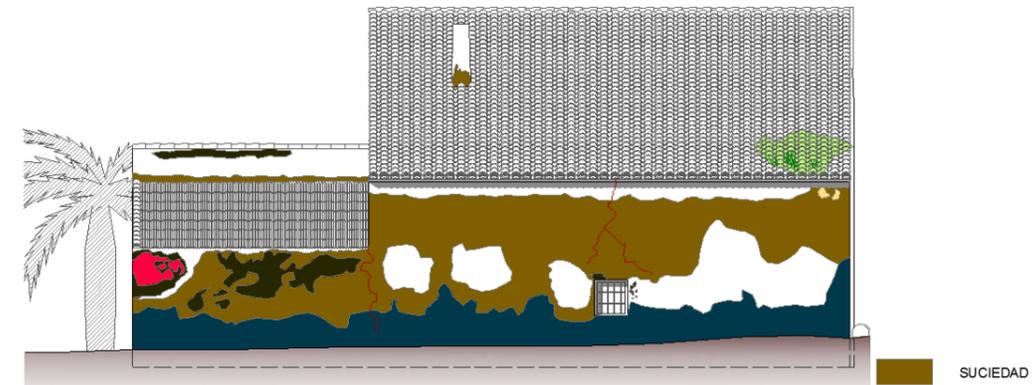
Fachada norte alquería Visquet. Fuente: autor propio
